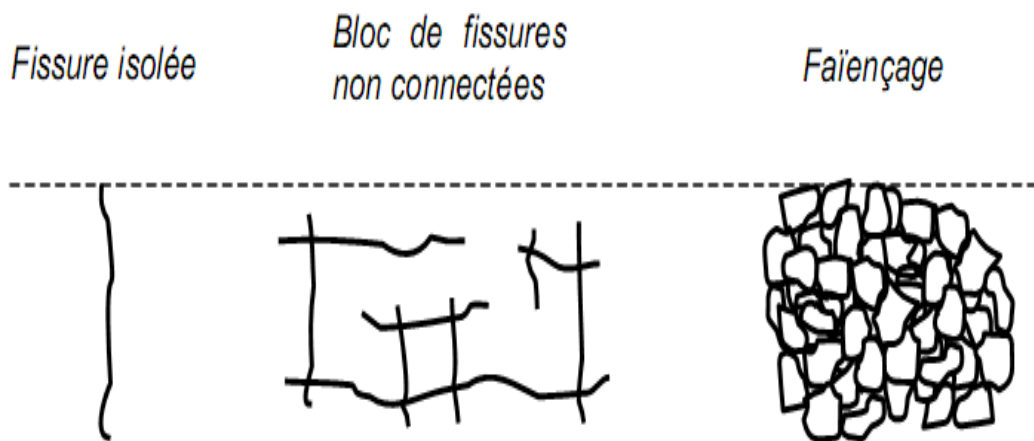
7 – Différents chemins de fissuration (vue de haut de la chaussée)
